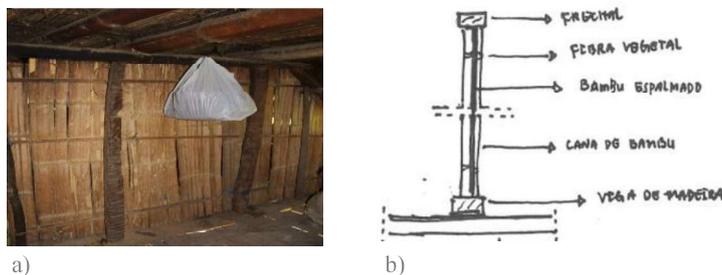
32. Tipos de parede de bambu. a) Parede de bambu espalmado colocado em vertical b) Desenho em corte da parede.
